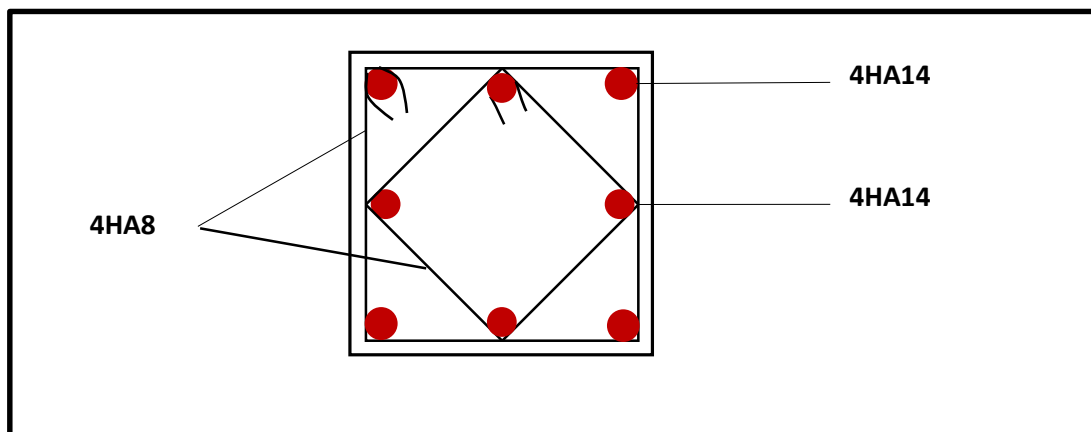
Ferrailage Poteau 35x35.
